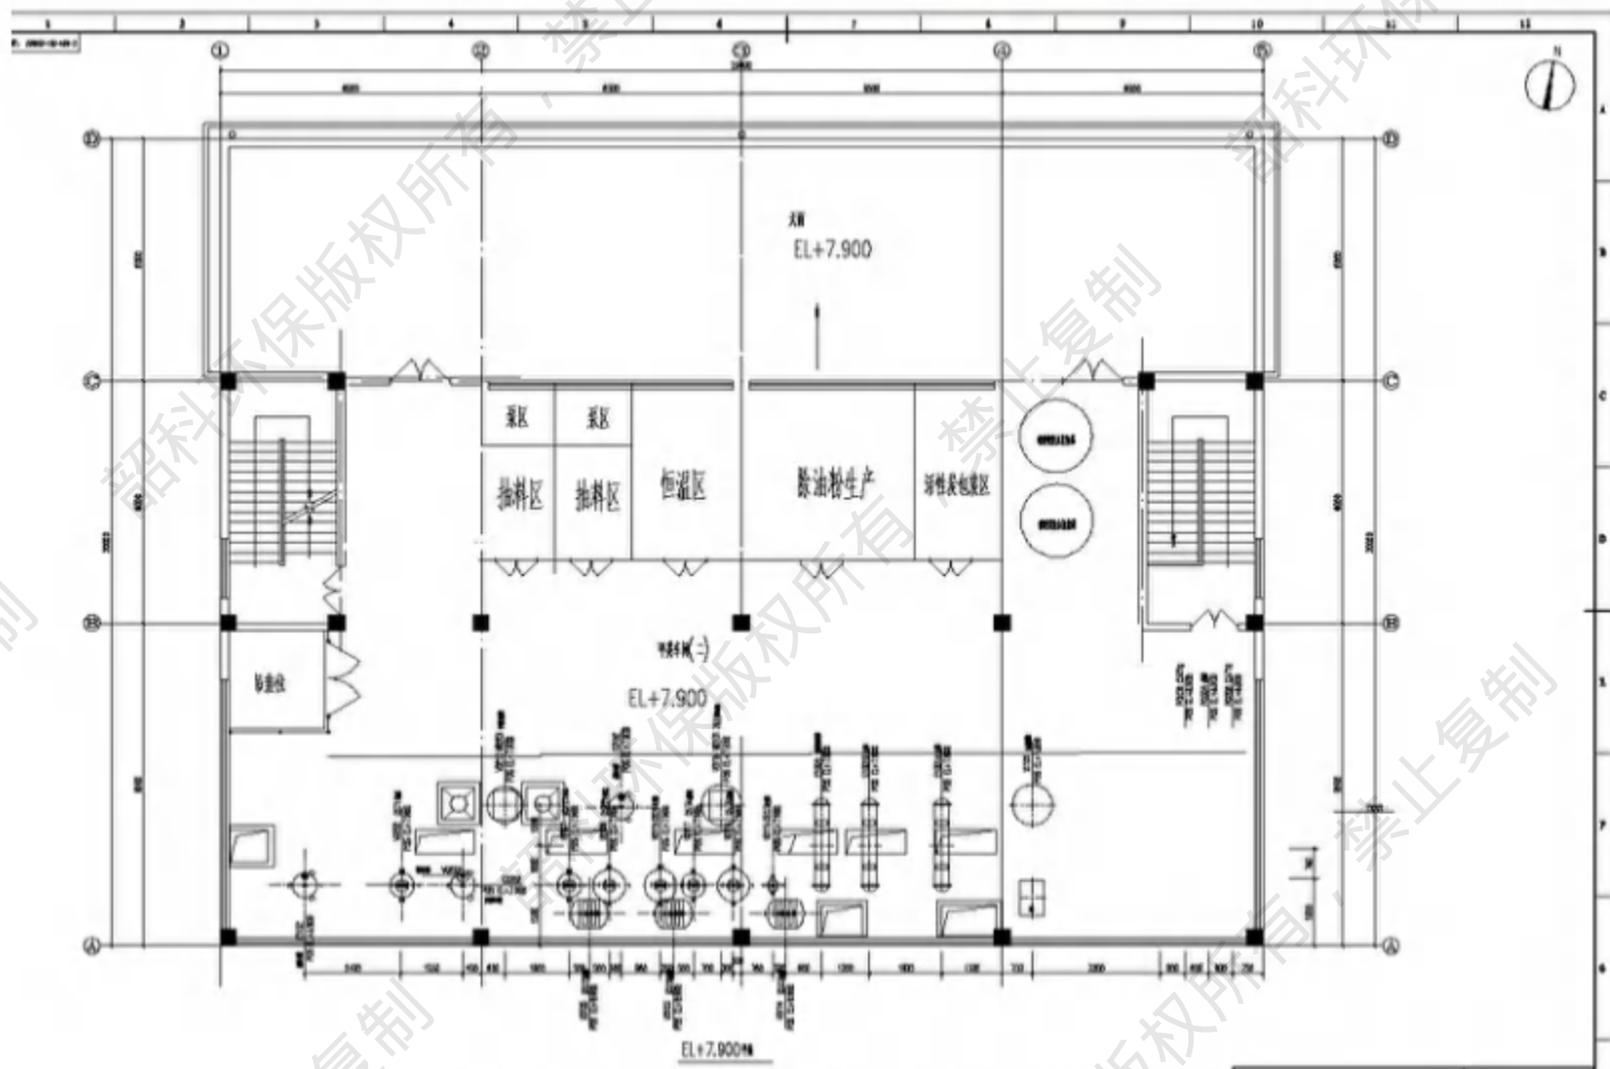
甲类车间二生产设备及环保设施布置平面图（三层）
